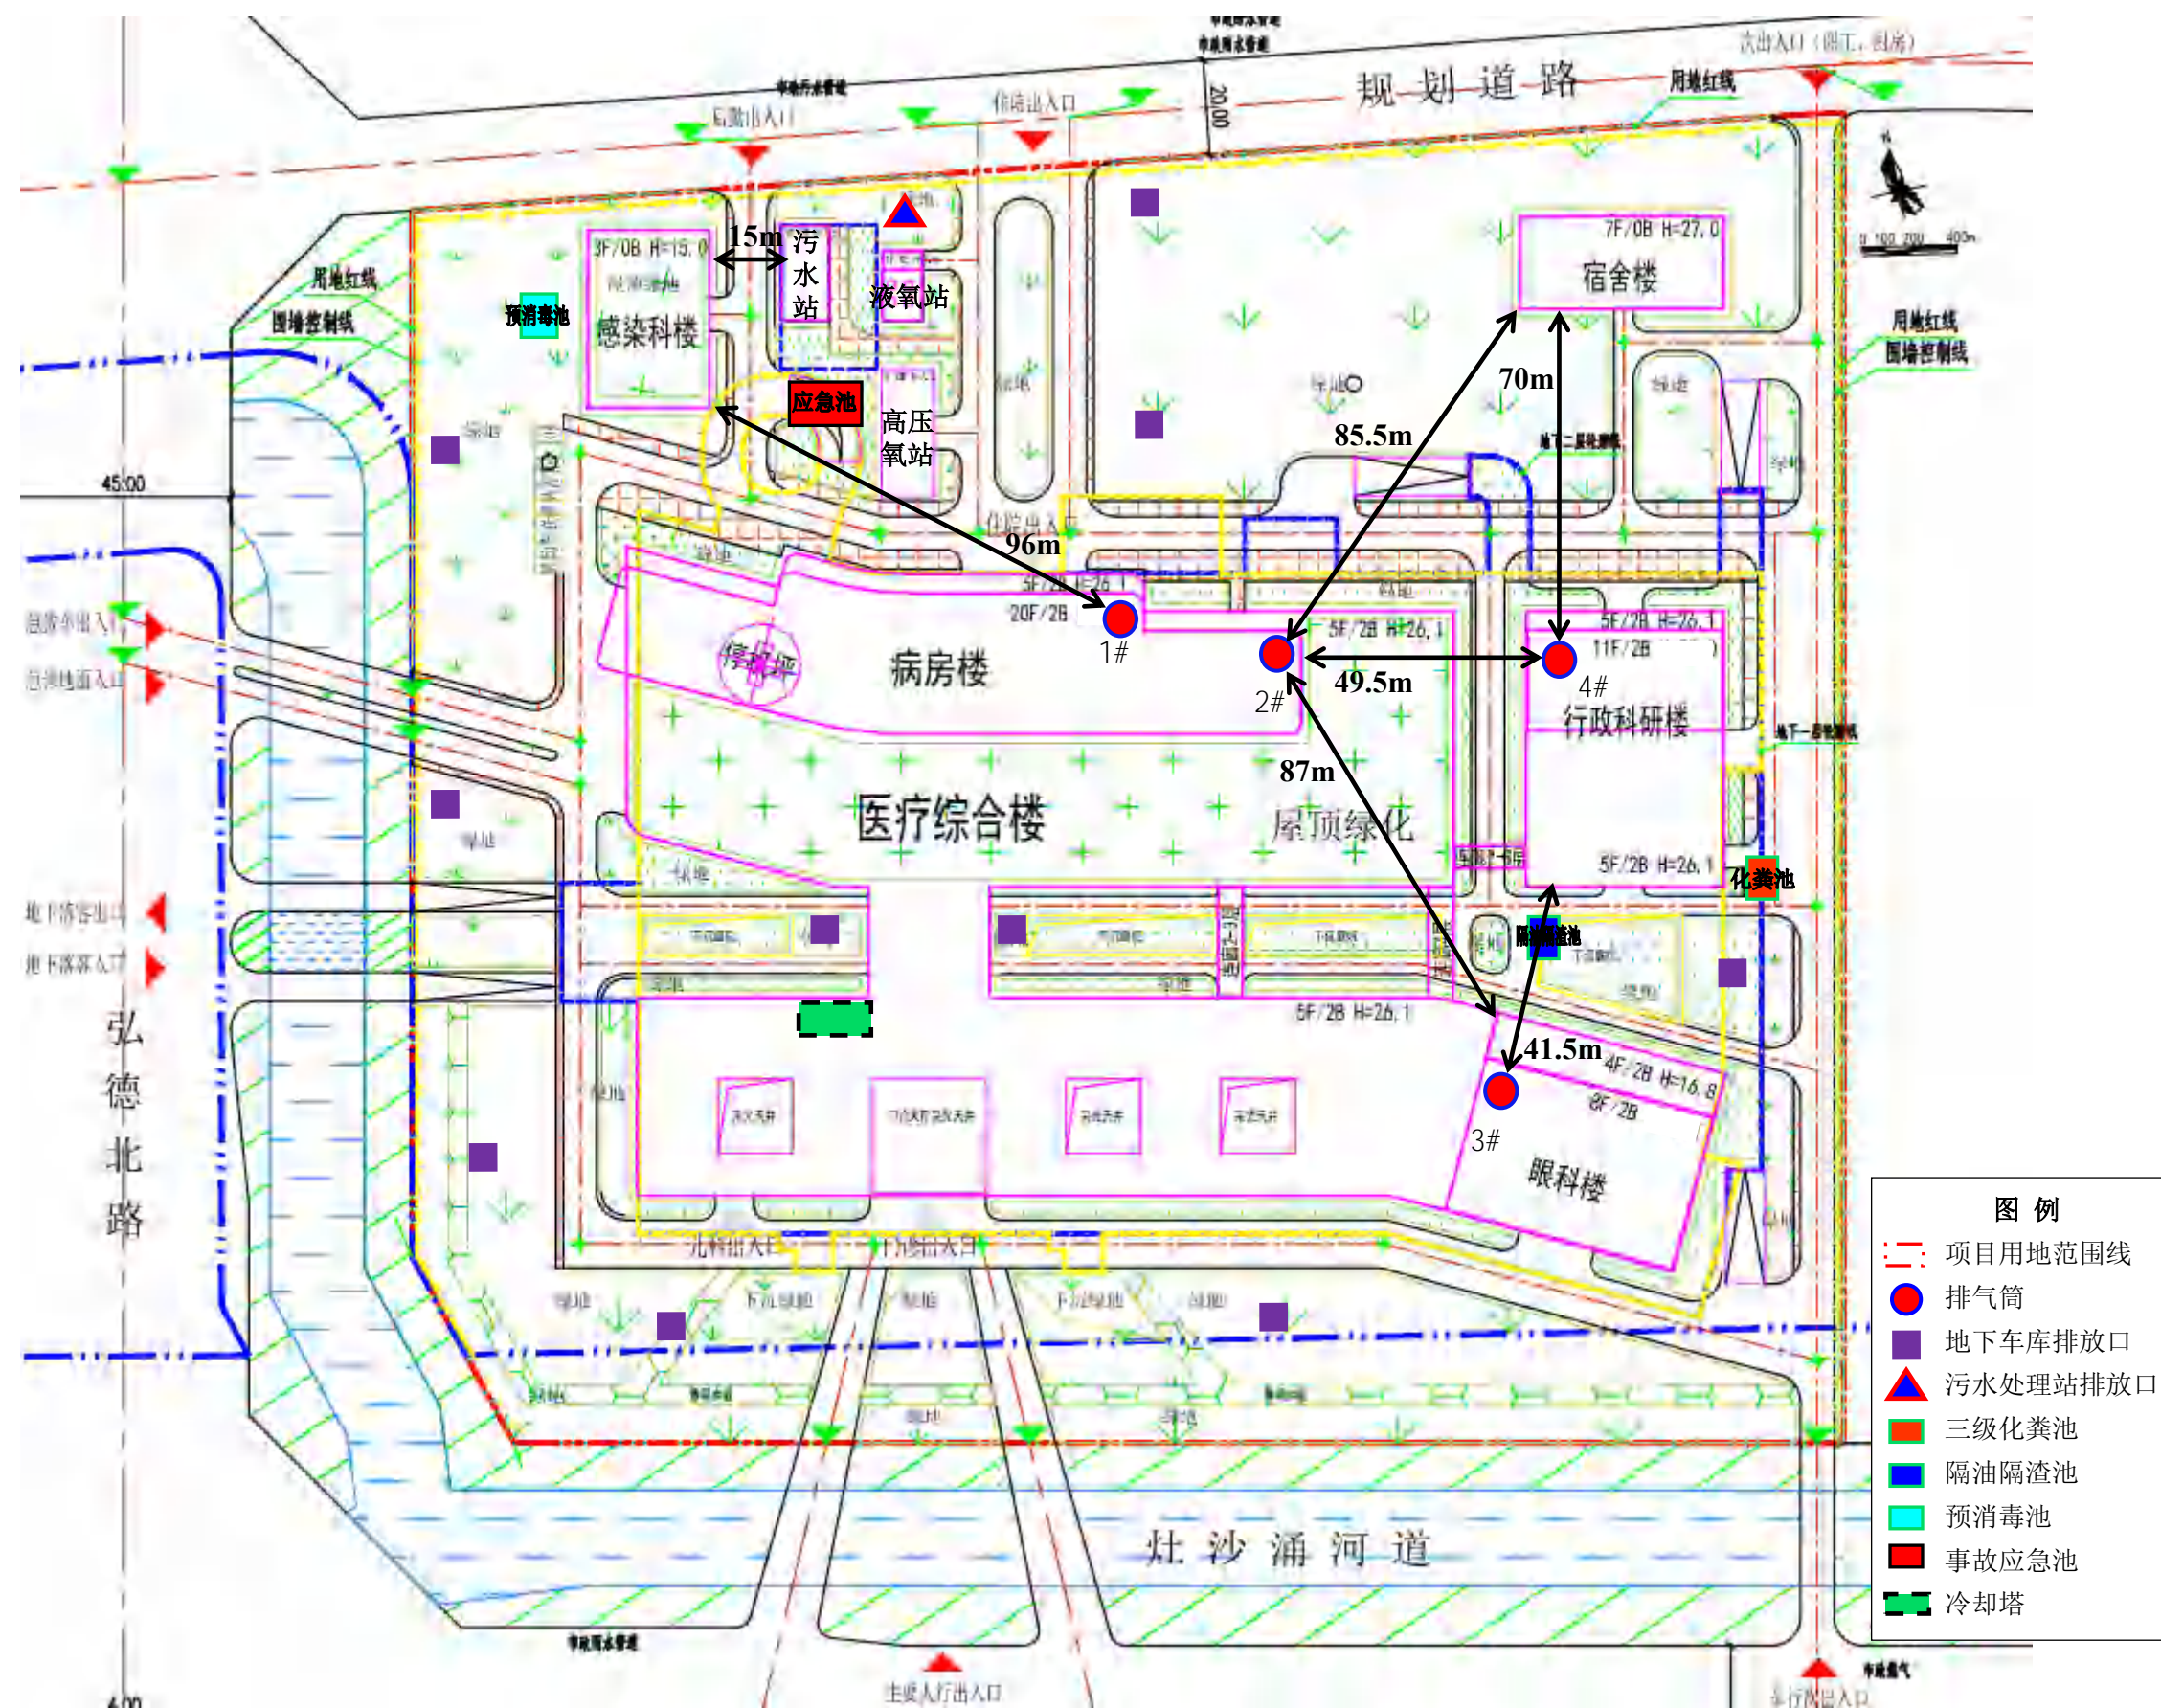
项目总平面布置图 (比例尺: 1:1464)
